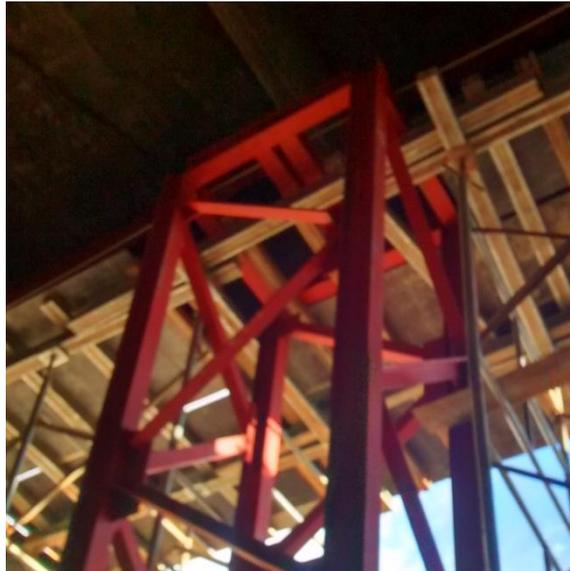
Viga metálica de apoio. (Fonte: Dos autores 2016)
